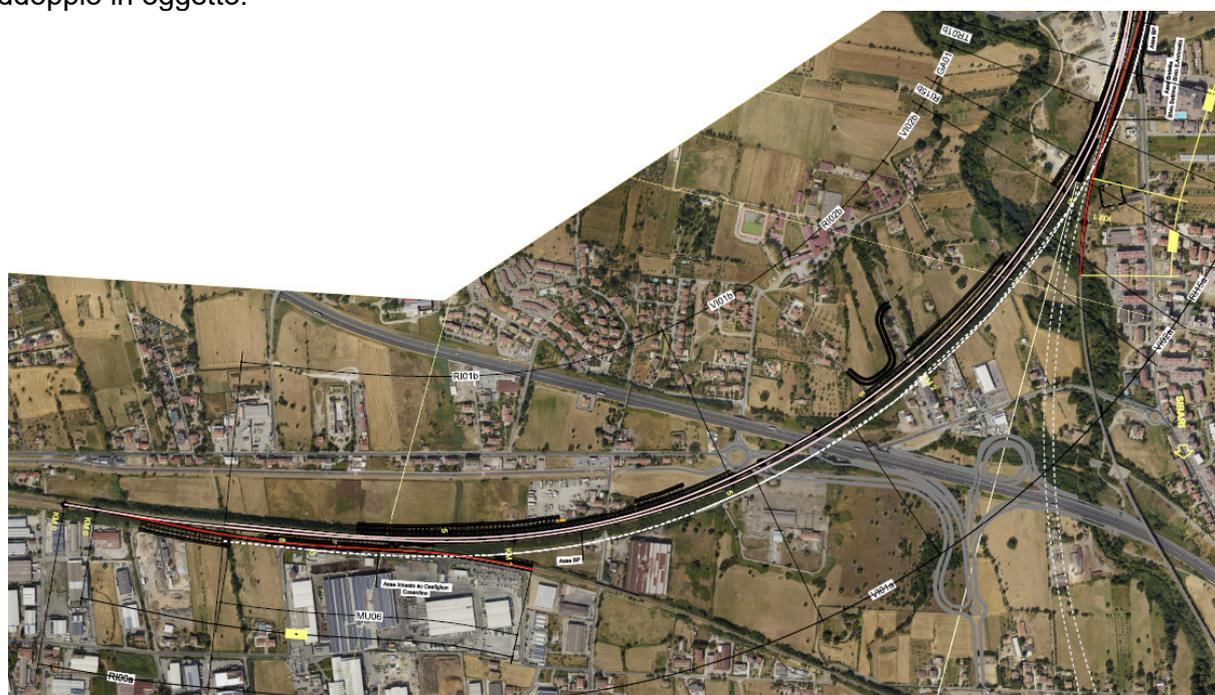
Stralcio planimetria su ortofoto da inizio tracciato alla GA01, compresa la variante 1 Linea Sibari
